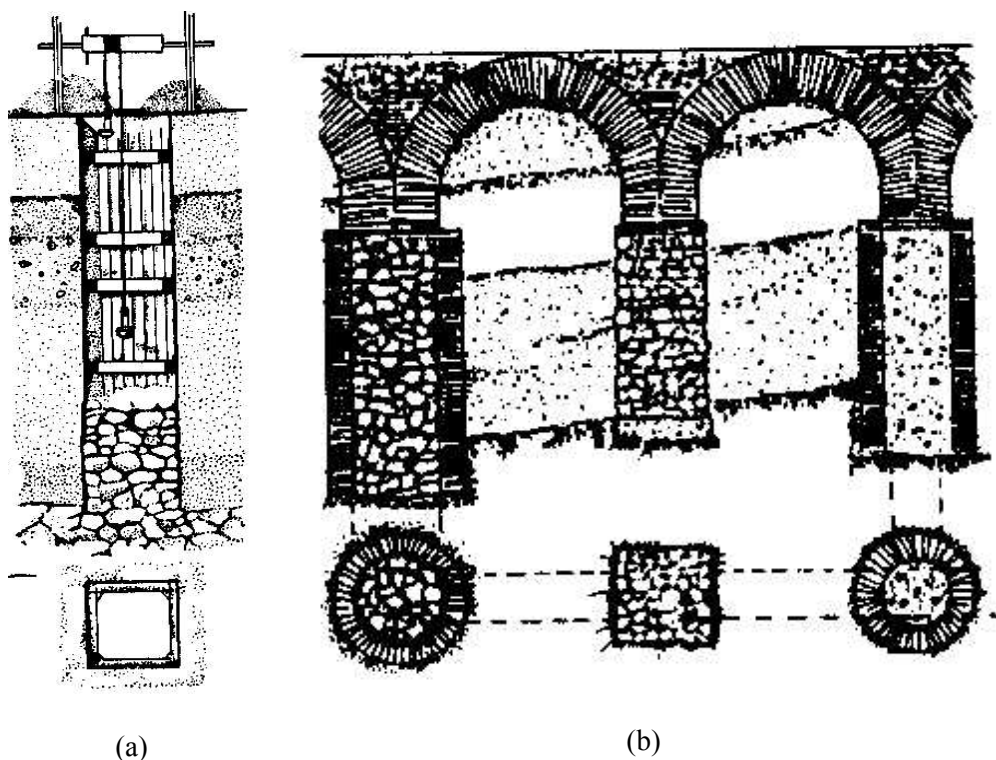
Fundações sobre poços de alvenaria [Piccirilli, 1996]: (a) execução de um poço: a escavação, o escoramento e o enchimento; (b) arcos de fundação assentes sobre poços de alvenaria de diferentes tipologias.
